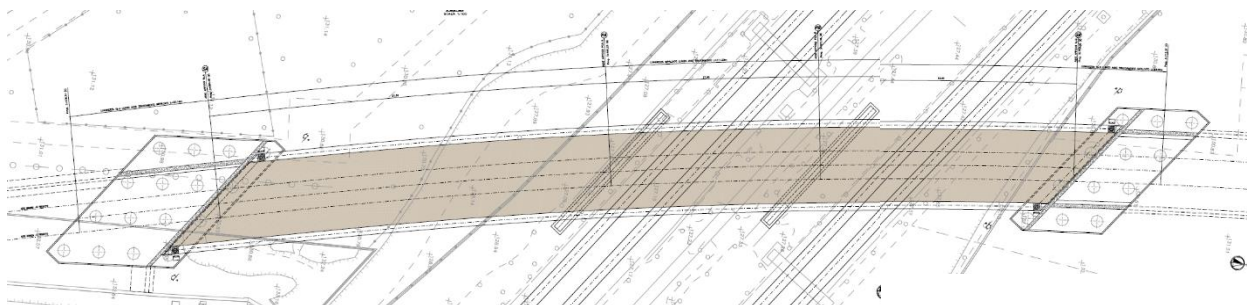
Pianta manufatto di scavalco su linea RFI.
